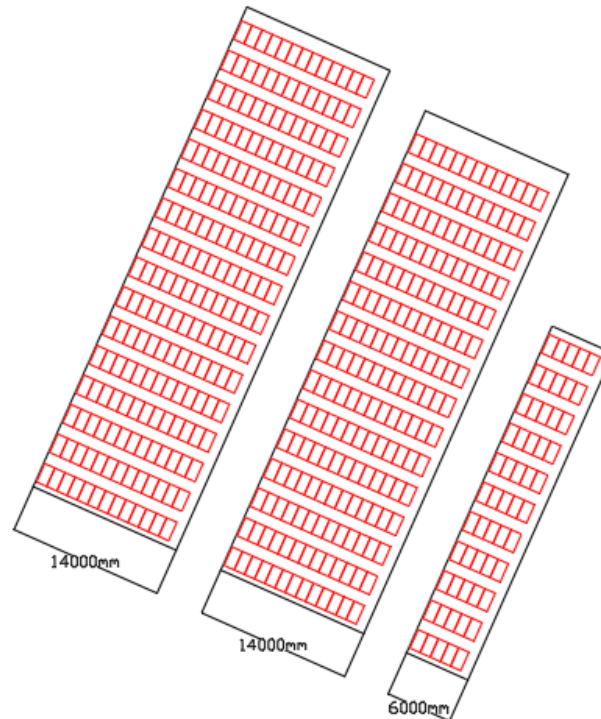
Disposición de los paneles en las cubiertas. Fuente: propia, AutoCAD.
